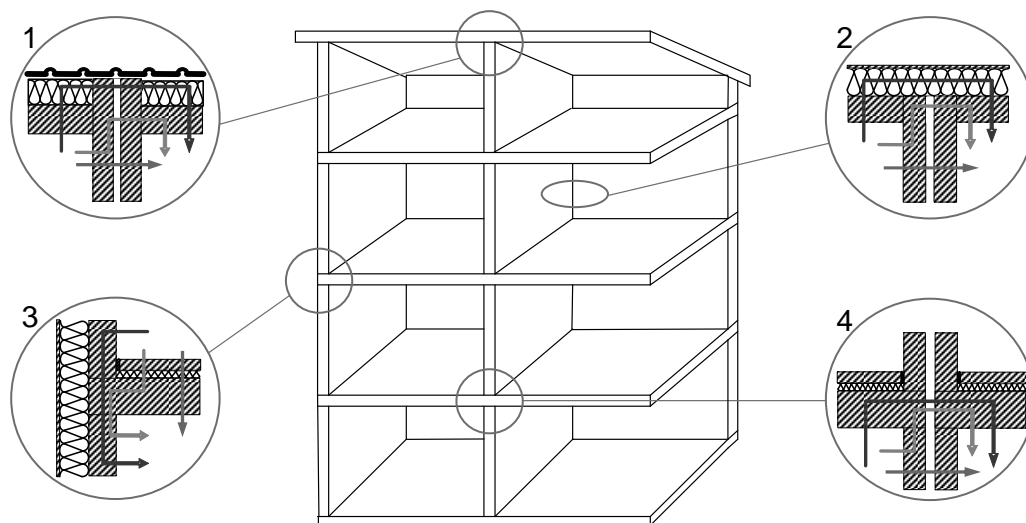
Geschosswohnungsbau in Massivholzbauweise mit Prinzipdetails der Stoßstellen und den Schall-Übertragungswegen.
